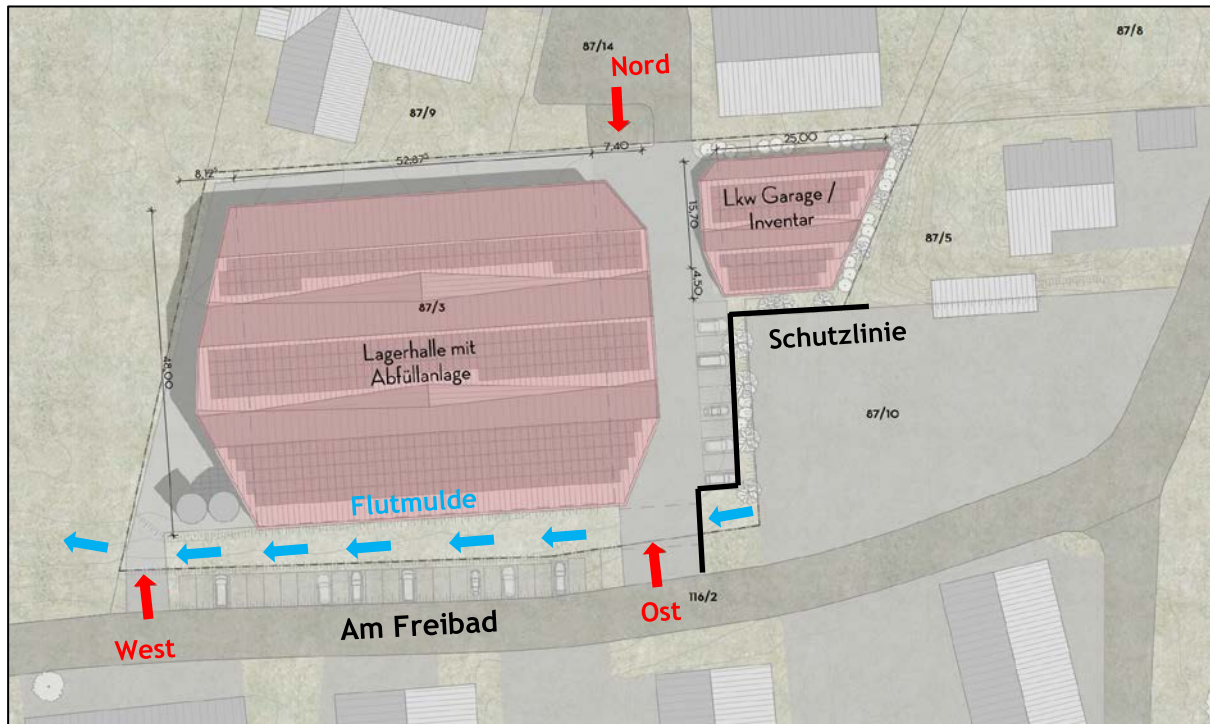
Lageplan „Bauleitplanung Schöffler Abfüllanlage und Lagerhalle“ (Ausschnitt); skizzierter Verlauf der Flutmulde (blau); skizzierter Verlauf der Schutzlinie (schwarz); Zufahrten zum Gelände (rote Pfeile); (© Alpstein Architekten)
